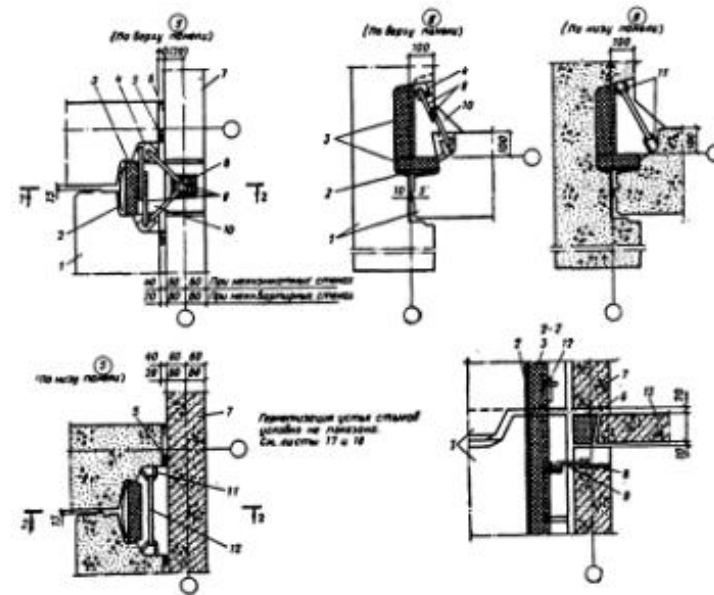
Узлы 5 и 6 сопряжений панелей наружных и внутренних стен: 1 - панель наружной стены; 2 — воздухозащитная прокладка; 3 — утеплитель; 4 — стальная штампованная пластинка; 5— деревянная рейка; 6 — цементный раствор; 7 — панель внутренней стены; 8 — закладная деталь; 9—соединительная полускоба; 10 — бетон замоноличивания; 11 - арматурные выпуски; 12—соединительная скоба; 13—панель перекрытия
